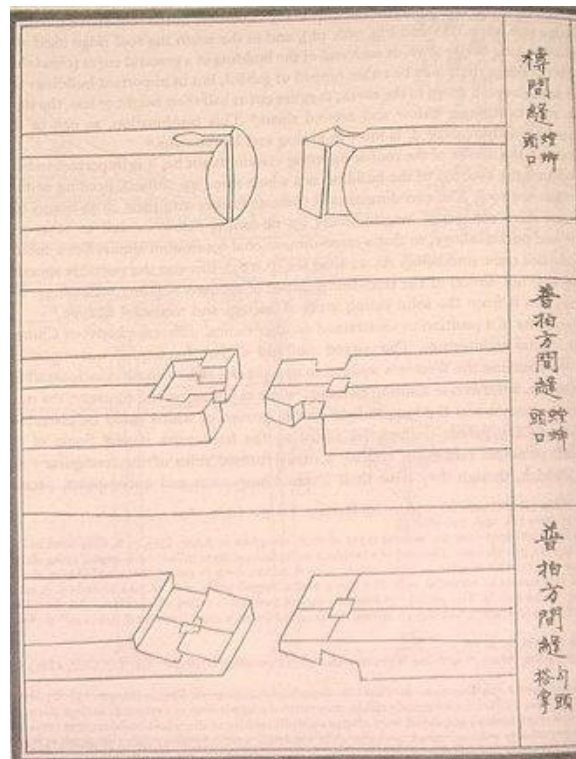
Detalles de vigas de unión y transversales, Yingzao Fashi.
